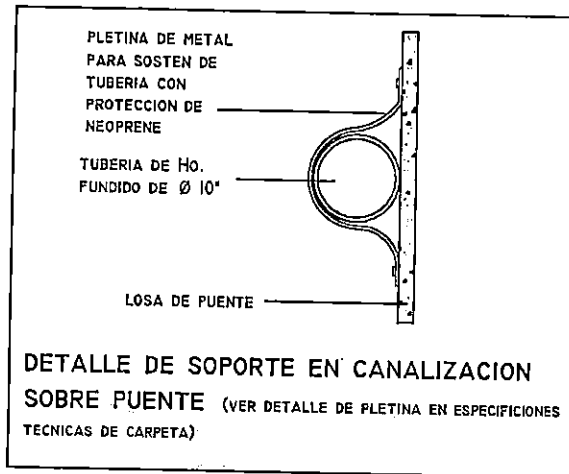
Esquema mostrando posición de la tubería en puente hacia planta de tratamiento.
